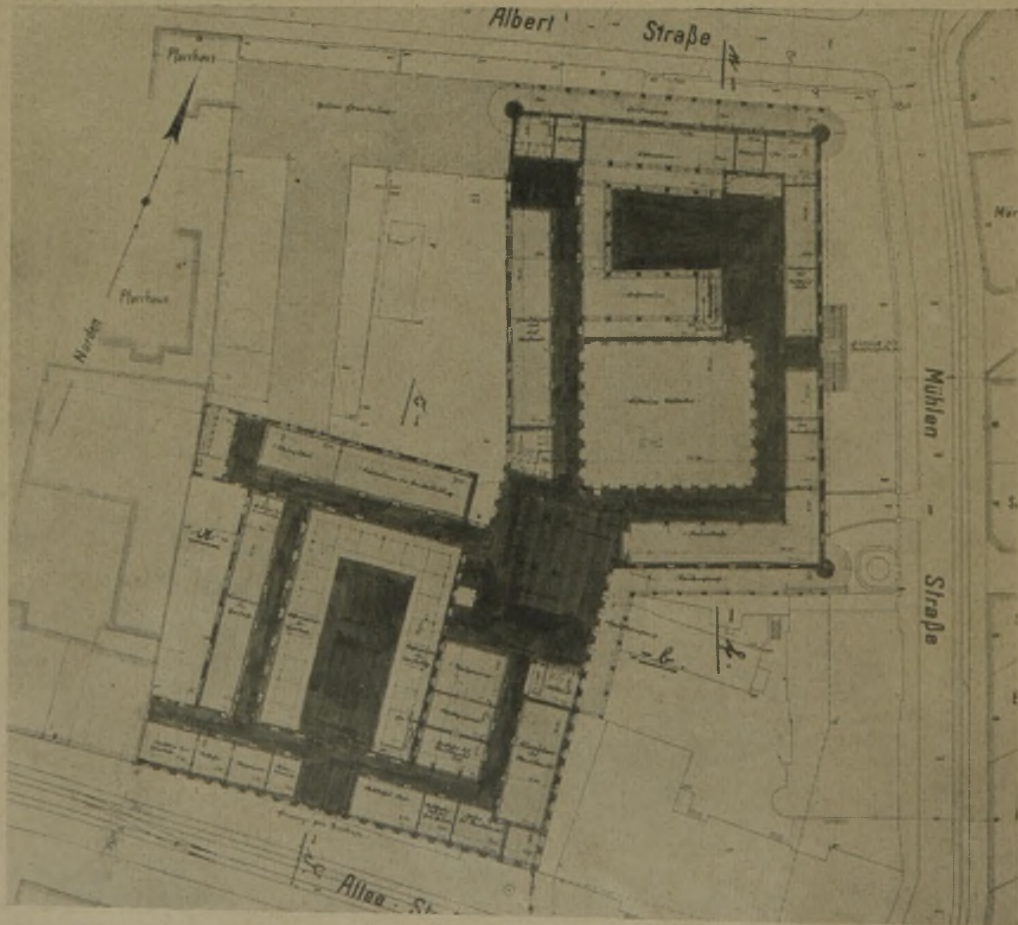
Erdgeschossgrundriß (1 : 1000). II. Preis von 12000 M. Kenawort: „Ravenna“.
